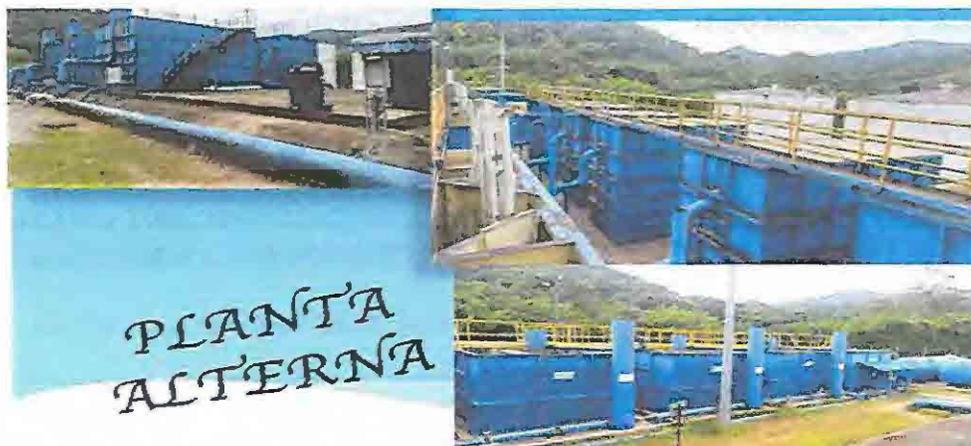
Sistema de tratamiento alterno (Planta alterna y Conciliada)
